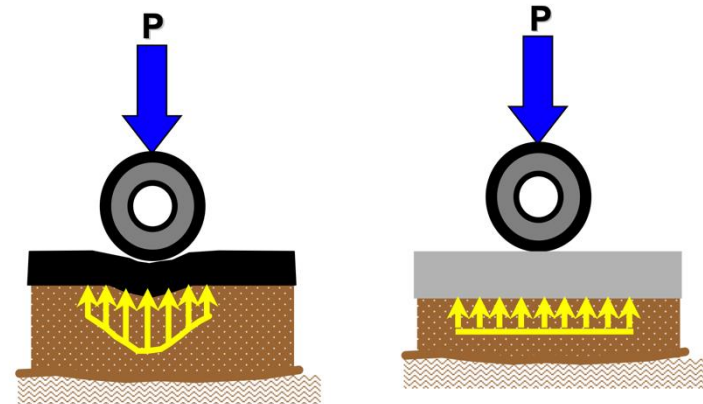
Presiones al suelo, Instituto Mexicano del cemento y del concreto, A.C. (IMCYC), [http://www.imcyc.com/50/pdfs/50a\\_PavimentosChih.pdf](http://www.imcyc.com/50/pdfs/50a_PavimentosChih.pdf)
